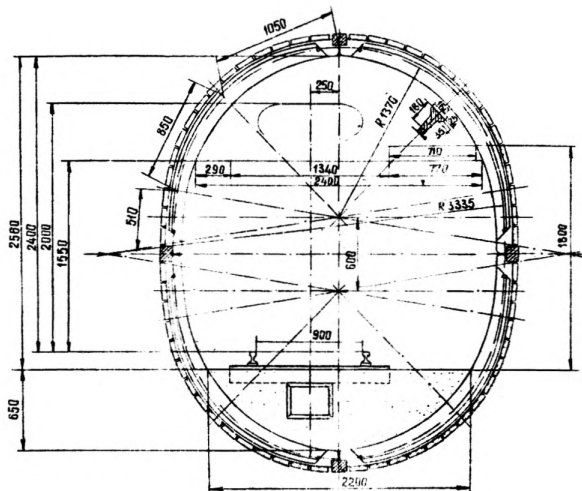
Железобетонная эллиптическая шарнирная крепь ЭЖК
